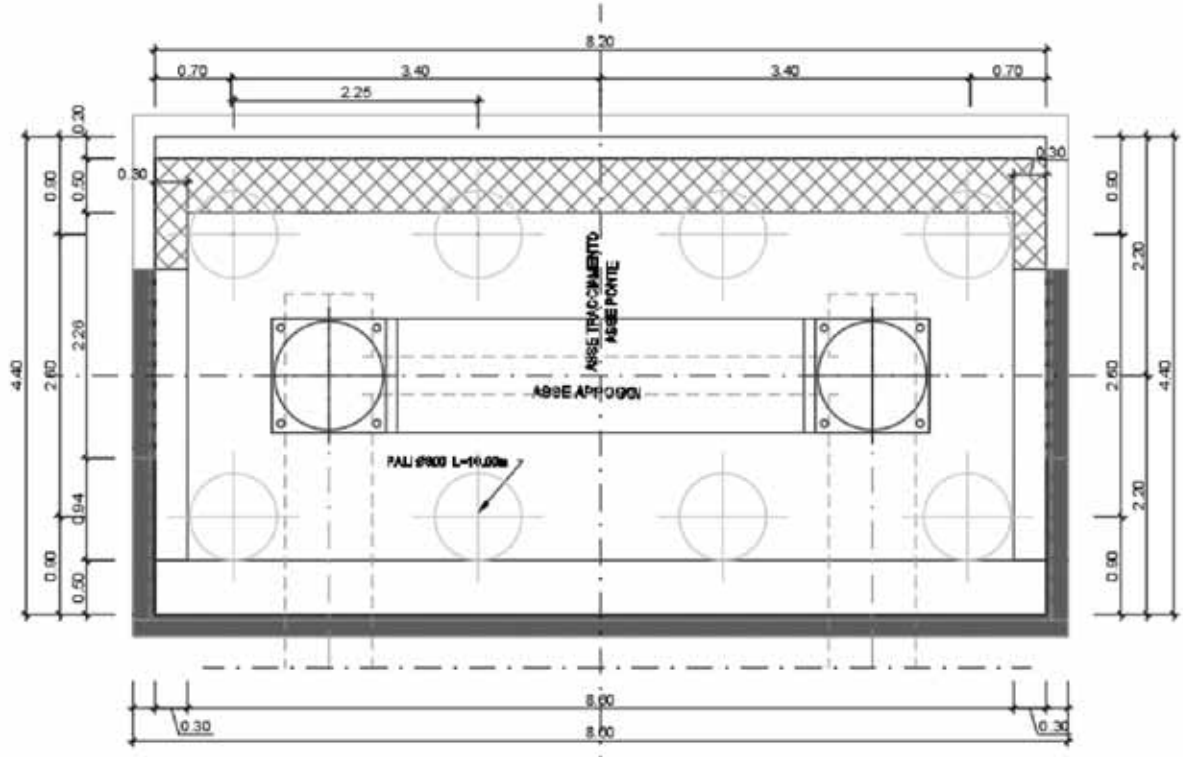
Pianta fondazione spalla Sx e della spalla Dx
